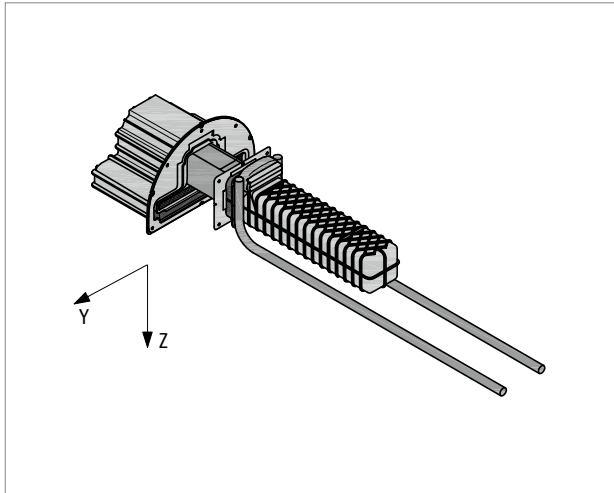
Schöck Tronsole® Typ P: 3D-Ansicht mit Achsbezeichnung
